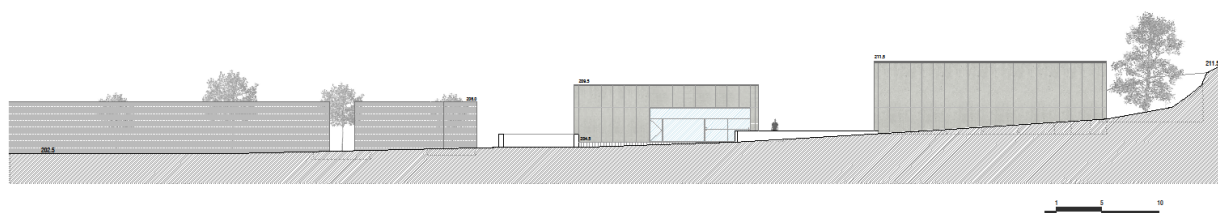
Proposta: Alçado Norte, Fonte: Autor
